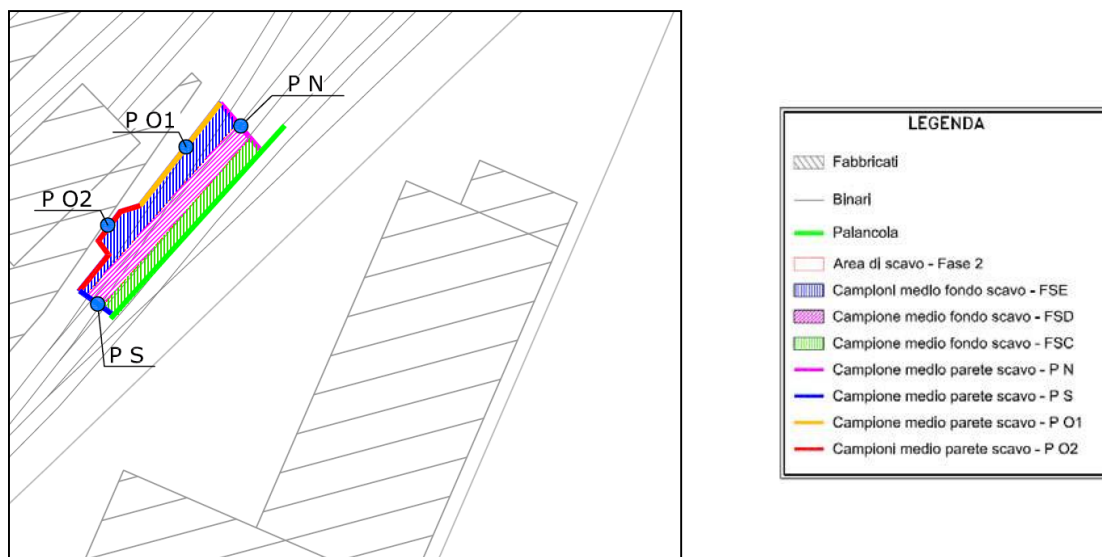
Campioni prelevati dallo scavo - Fase 2
